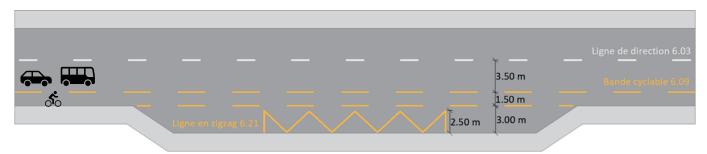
Schéma type d'un arrêt hors chaussée bordé d'une bande cyclable
